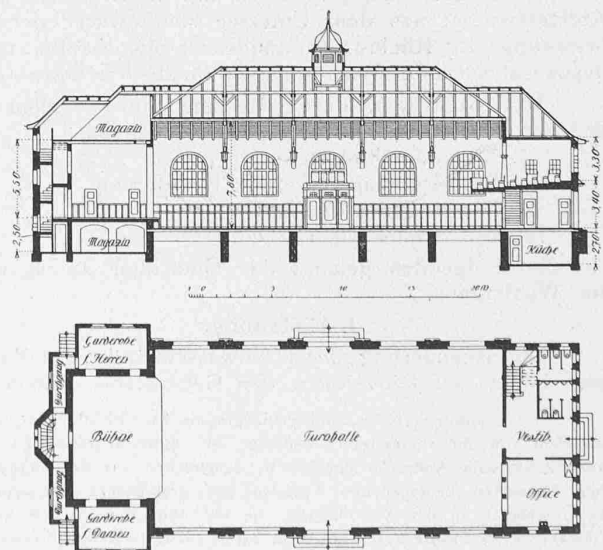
und 4. Grundriss und Schnitt. — Masstab 1:500.
